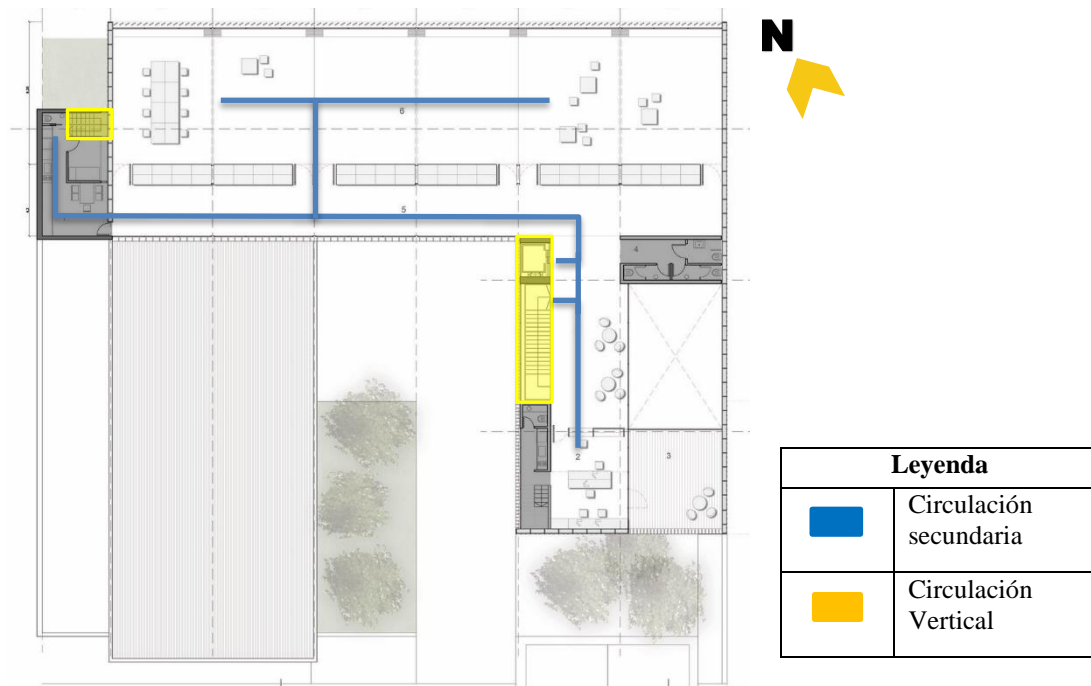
Circulación planta primer piso C. C. El Bolsón.
